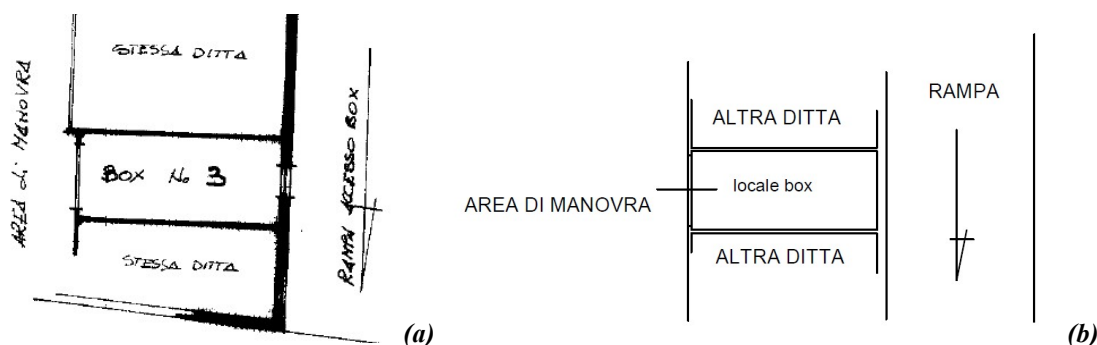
Planimetria del locale box in piano seminterrato ubicato in via Montecassino n° 10 – interno 3: planimetria catastale (a); planimetria attuale (b).
